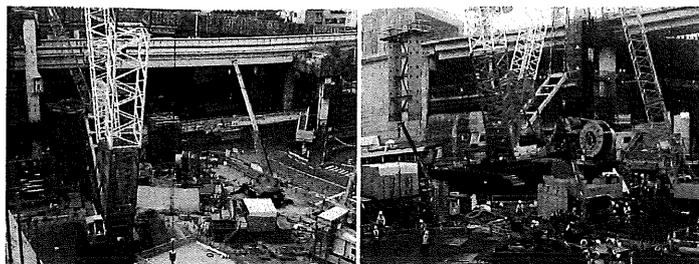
(2点) 連結路橋梁工事競合下の連壁施工に止水コーキングを施している(写真-4)。
